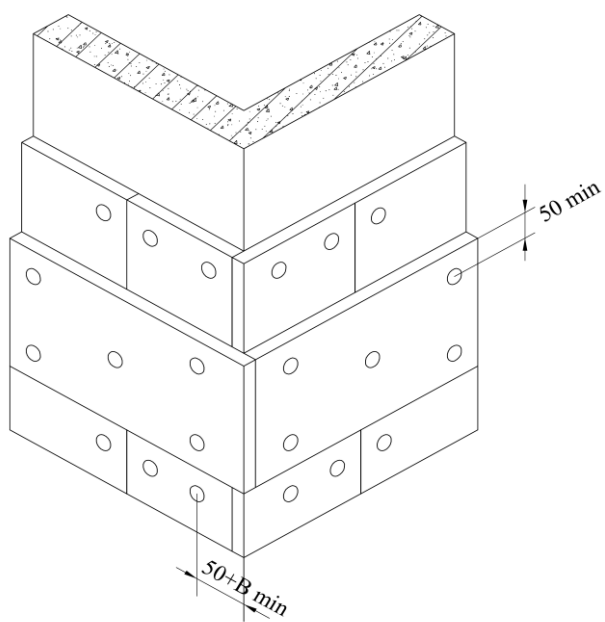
Схема крепления двухслойного утеплителя на углу здания
